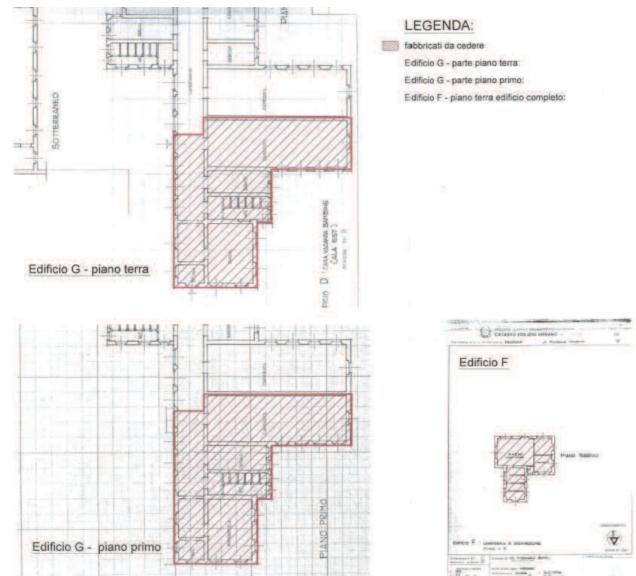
stralcio dalle schede catastali con i fabbricati proposti dal Consorzio (in rosso tratteggiato)
